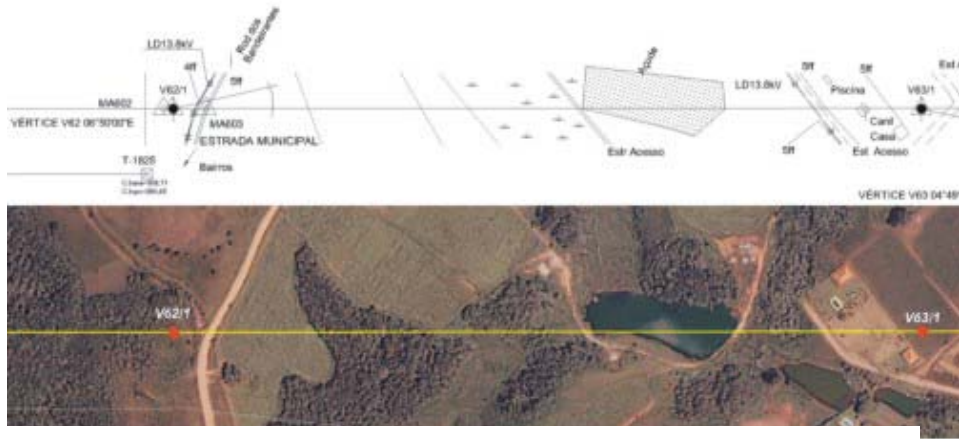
Detalhamento da Planta com Imagem do Satélite
